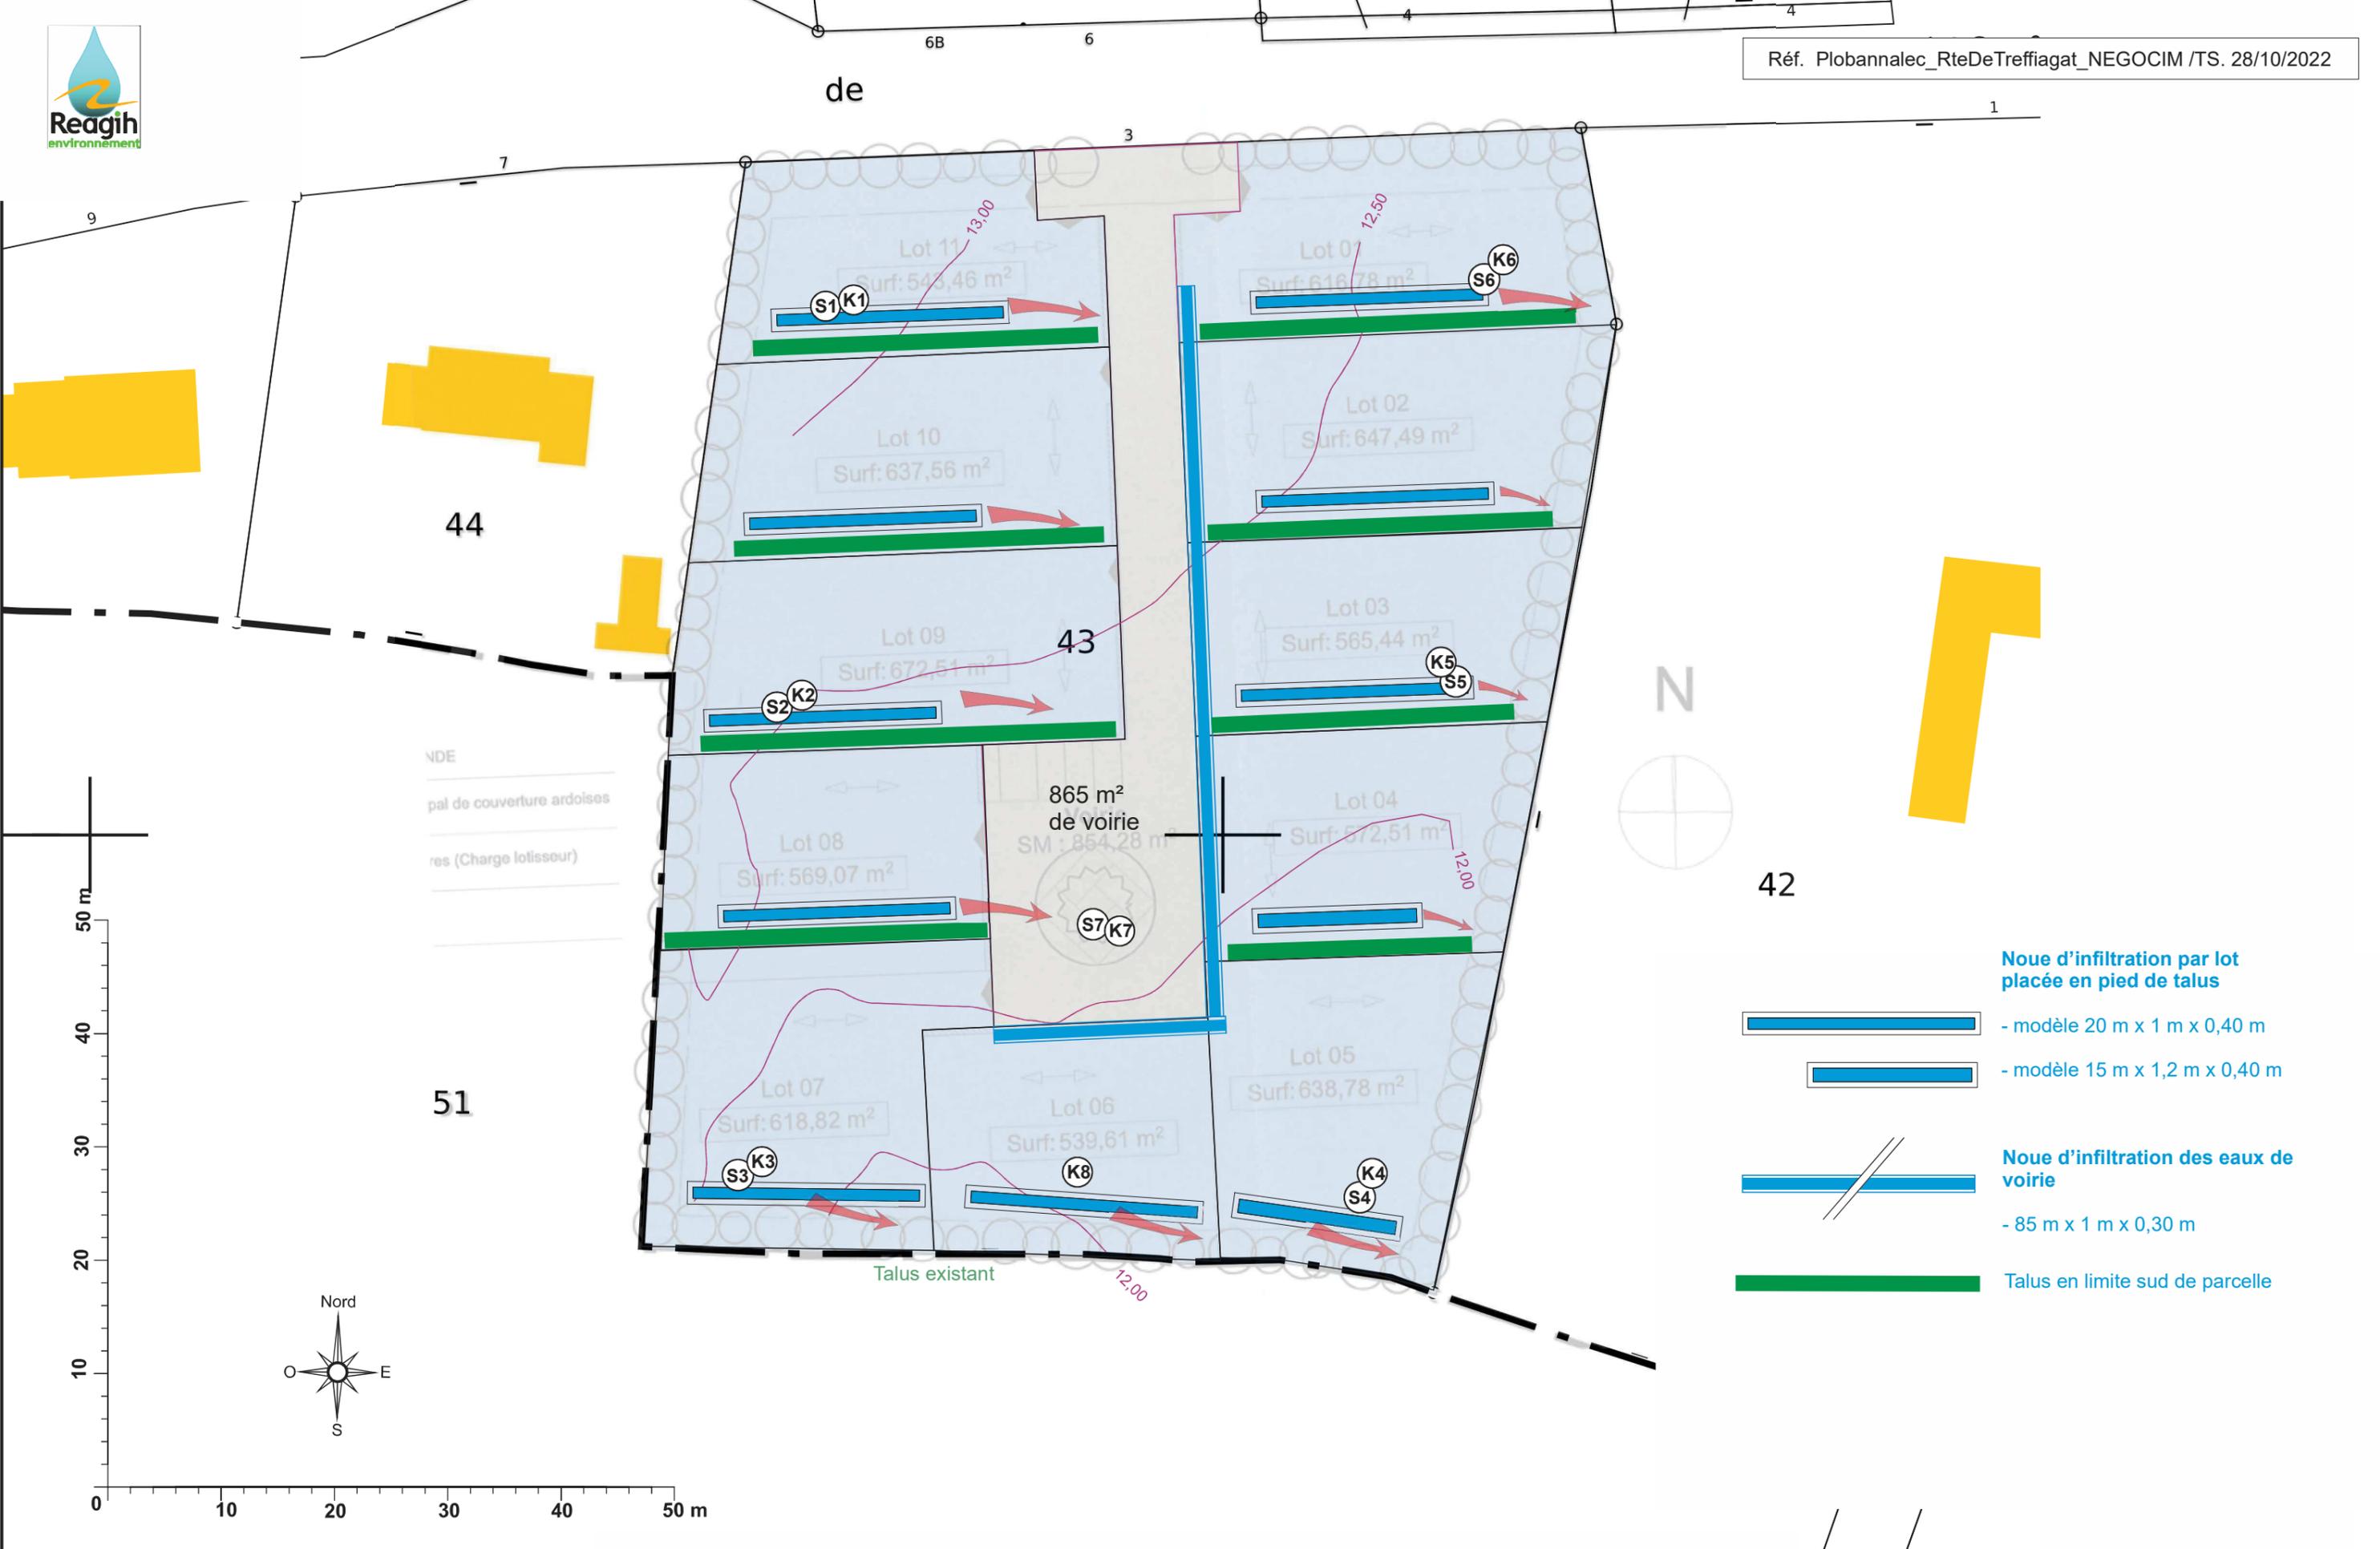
Report sur plan cadastral des observations et implantation de la structure de régulation des eaux pluviales.
